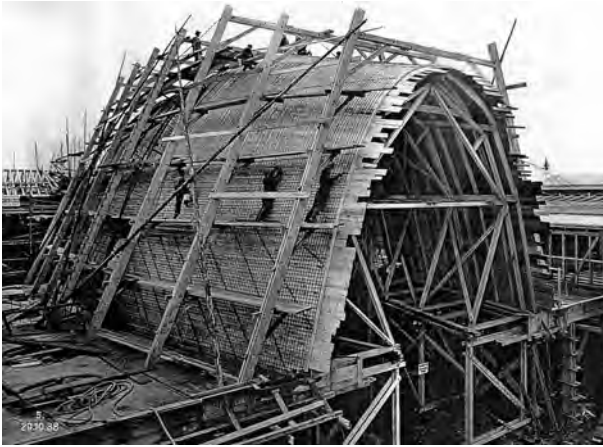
Robert Maillart: Cement Hall, Zúrique. Montagem das armaduras em 29 de outubro de 1938. [BELLINGTON, 1990]:226a
